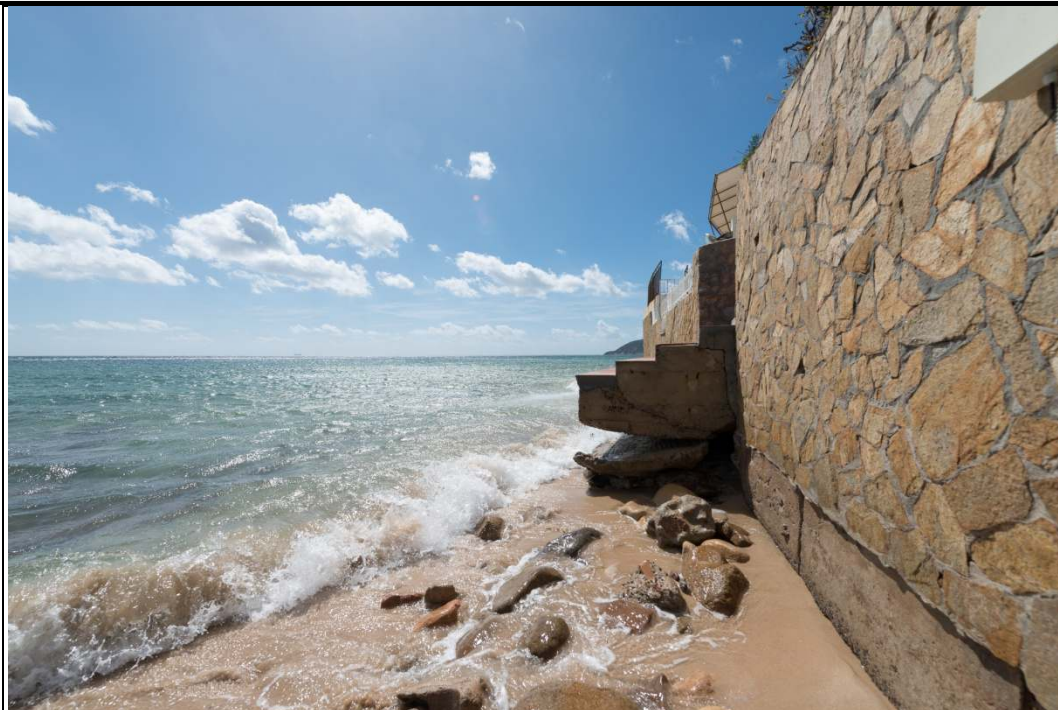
Foto del 19/03/2018. La Swash zone interessa la struttura muraria in quanto l'assetto di spiaggia è privo di berma. La configurazione del manufatto è precaria
